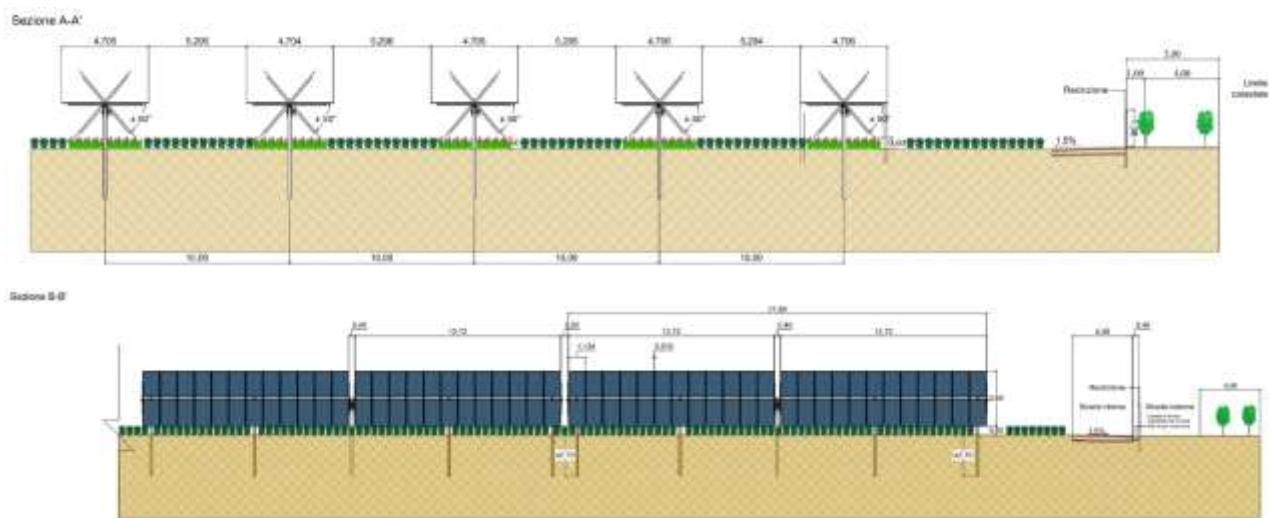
Sezione trasversale e longitudinale tipo di progetto
